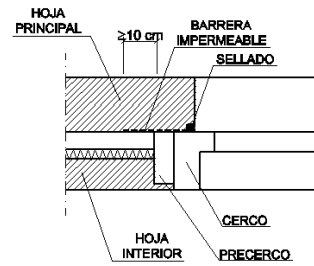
Ejemplo de encuentro de la fachada con la carpintería
